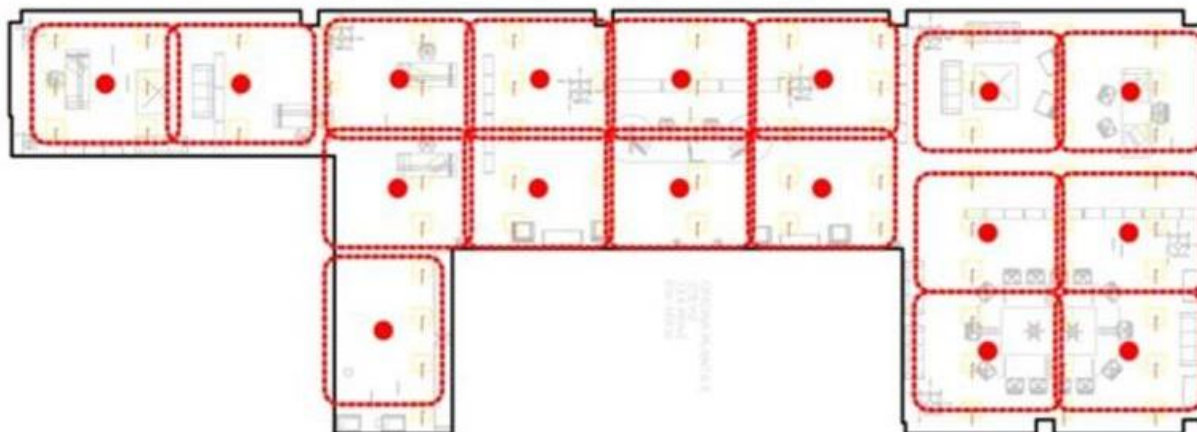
Distribución de Sensores. Área de Trabajo. Planta 5
